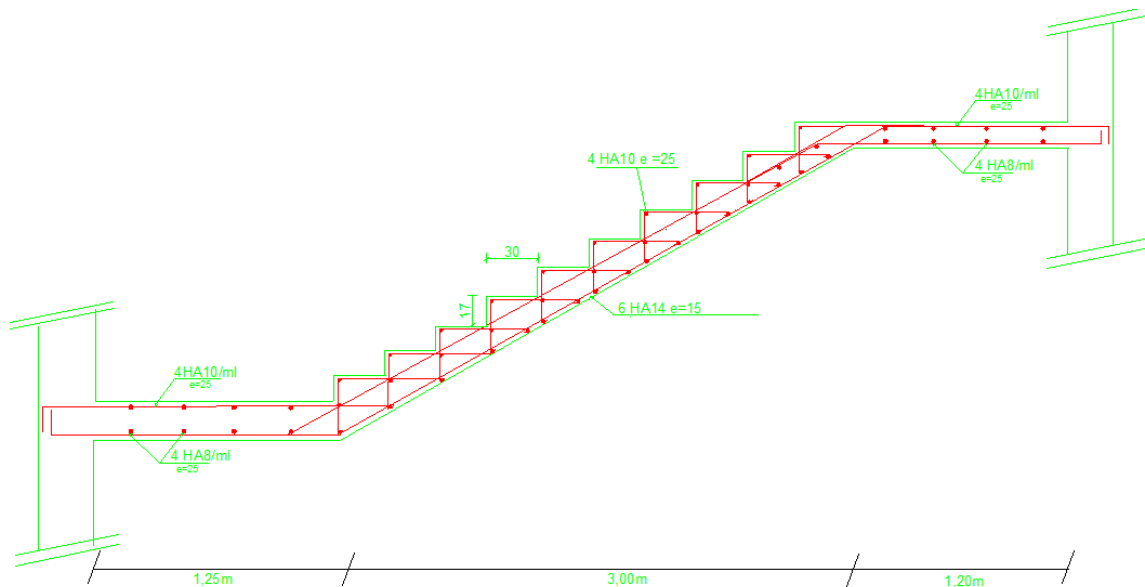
Plan de ferrailage 2^{ème} volée de RDC
